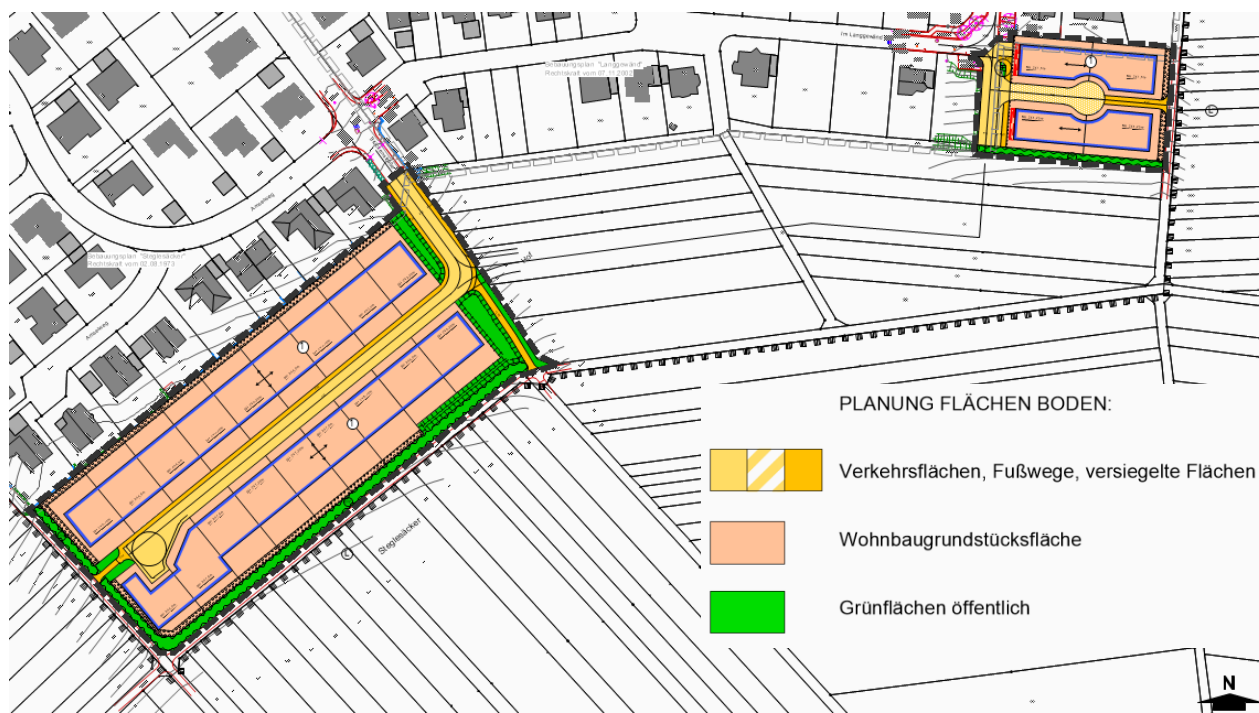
Bewertung Schutzgut Boden auf Grundlage des B-Plans „Langgewänd II West“, Quelle: mquadrat
